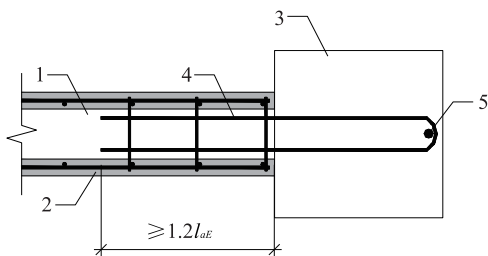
U型连接钢筋在边框柱中的锚固构造示意
